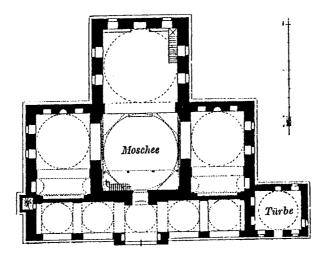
مسقط أفقي لجامع الفاتح الجديد باستانبول (عن : Gabriel) .
